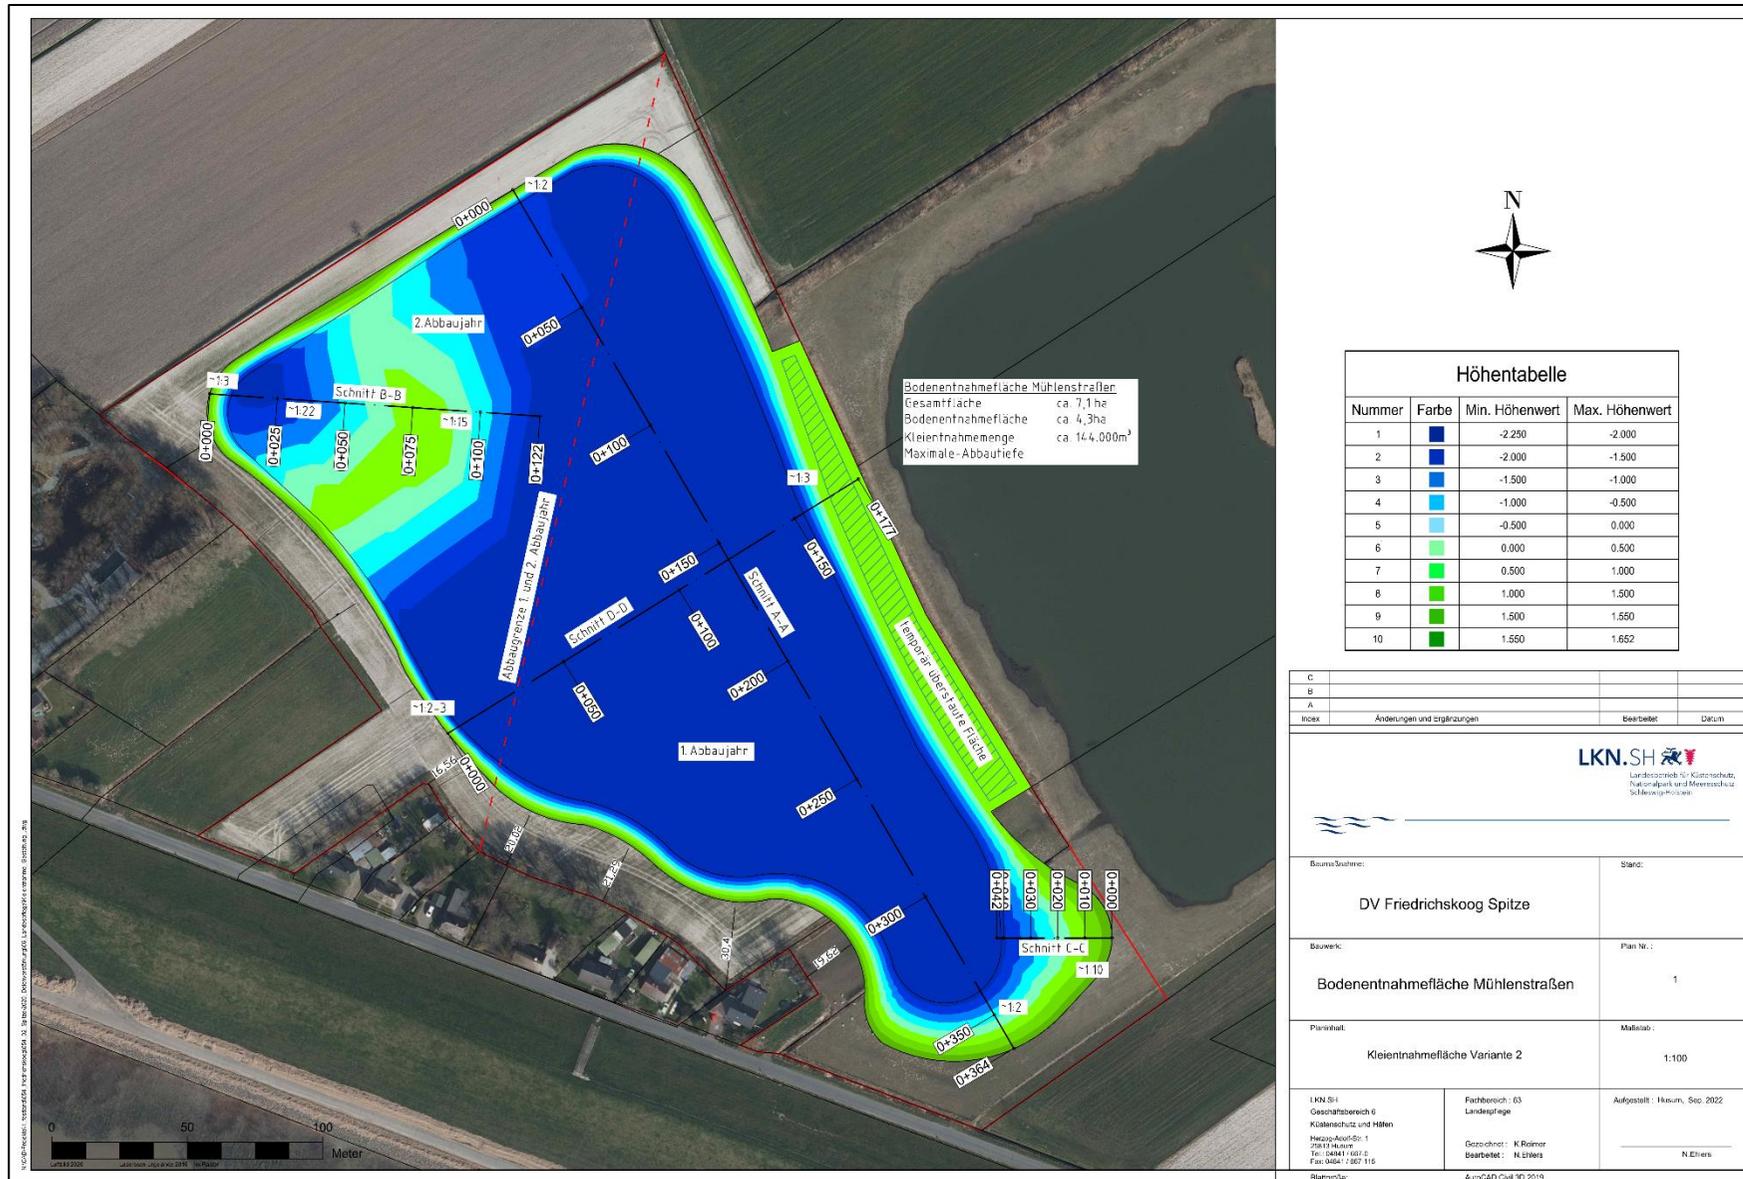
Lageplan mit der Darstellung des Höhenplans über NHN (Legende) (LKN.SH, 2022)
